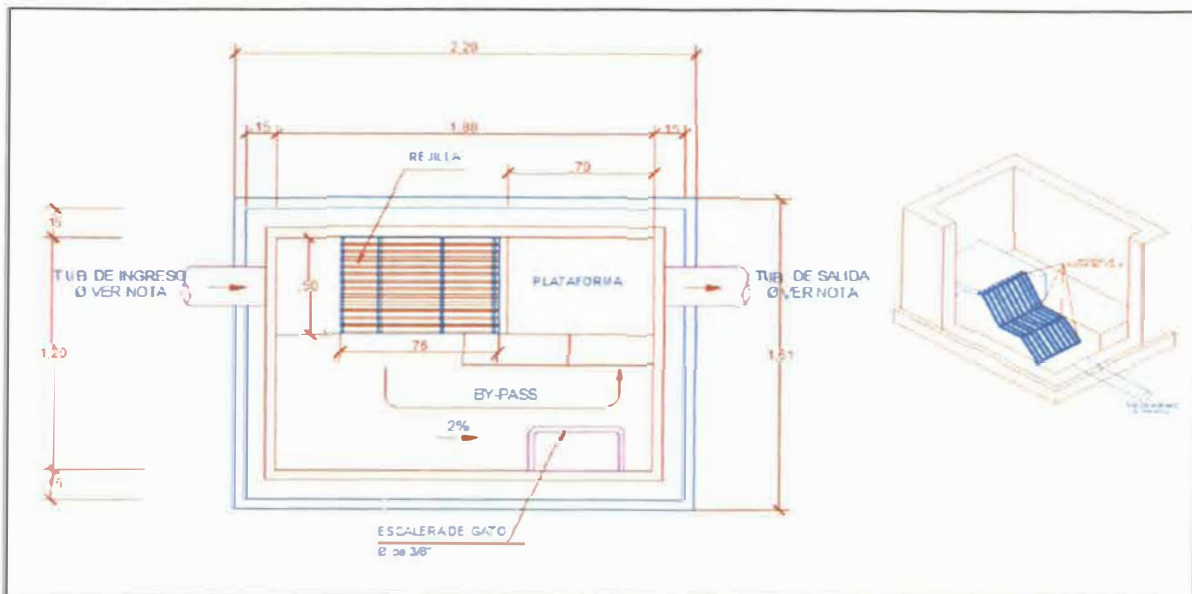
Esquema en Planta e Isométrico de la Cámara de Rejas
